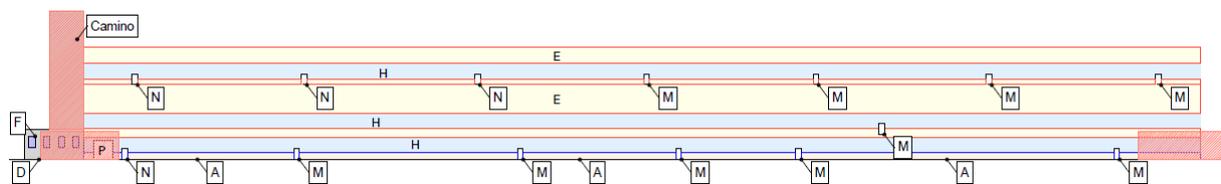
Dettaglio composizione architettonica prospetto nord
